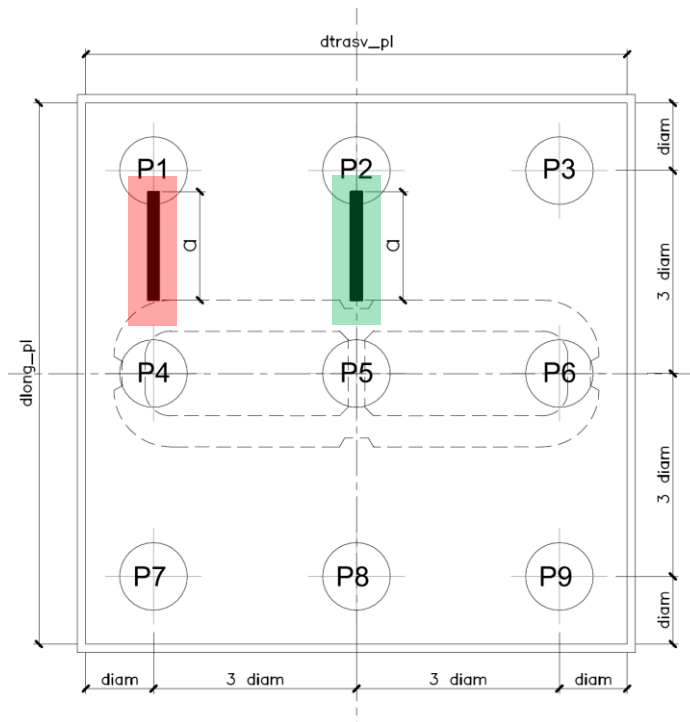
Vista in pianta - Tirante-puntone centrale (verde) e di spigolo (rosso)
